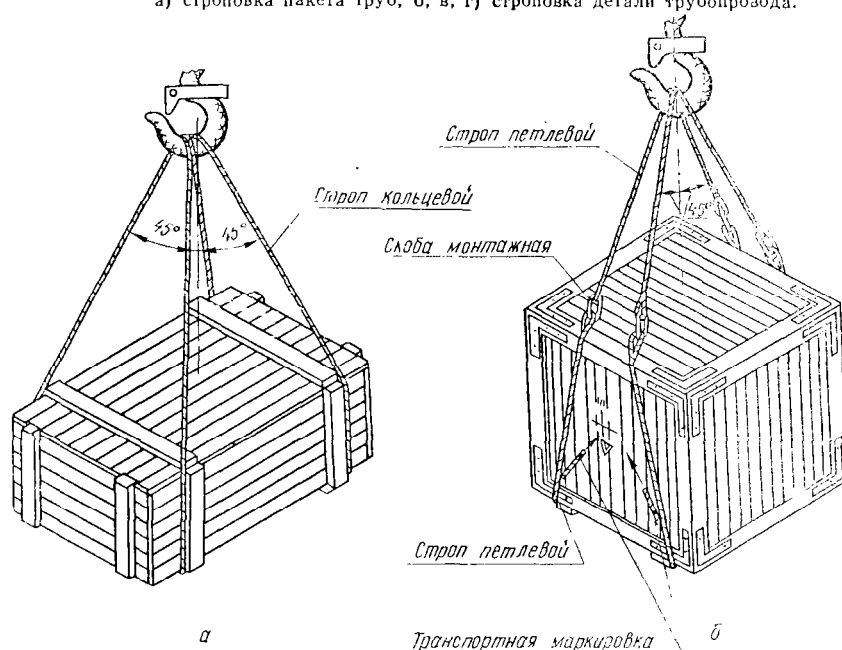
Схемы строповки крупногабаритных (тяжеловесных) ящиков:
